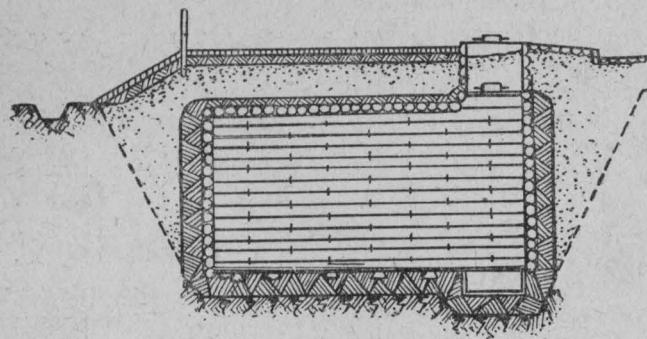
Подземный деревянный водоем с рублеными стенами.
